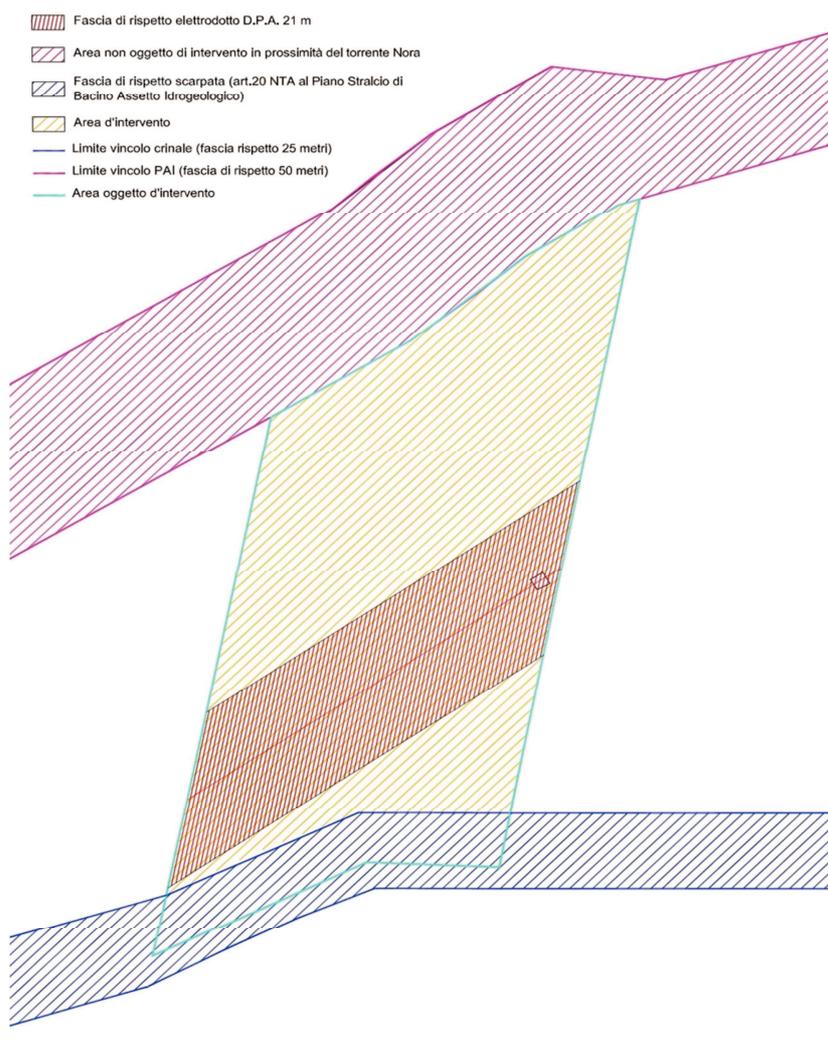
Planimetria di progetto con evidenziazione delle fasce di rispetto
